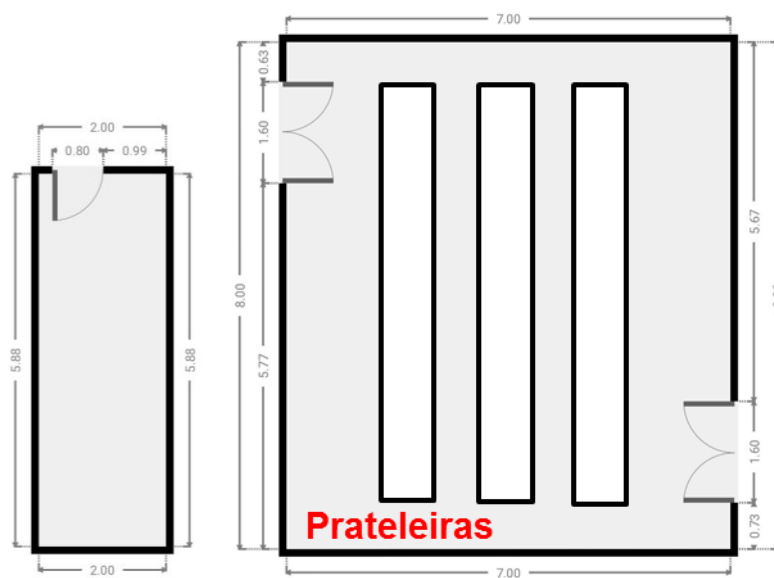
Layout da área de Armazenagem da Matéria-Prima
